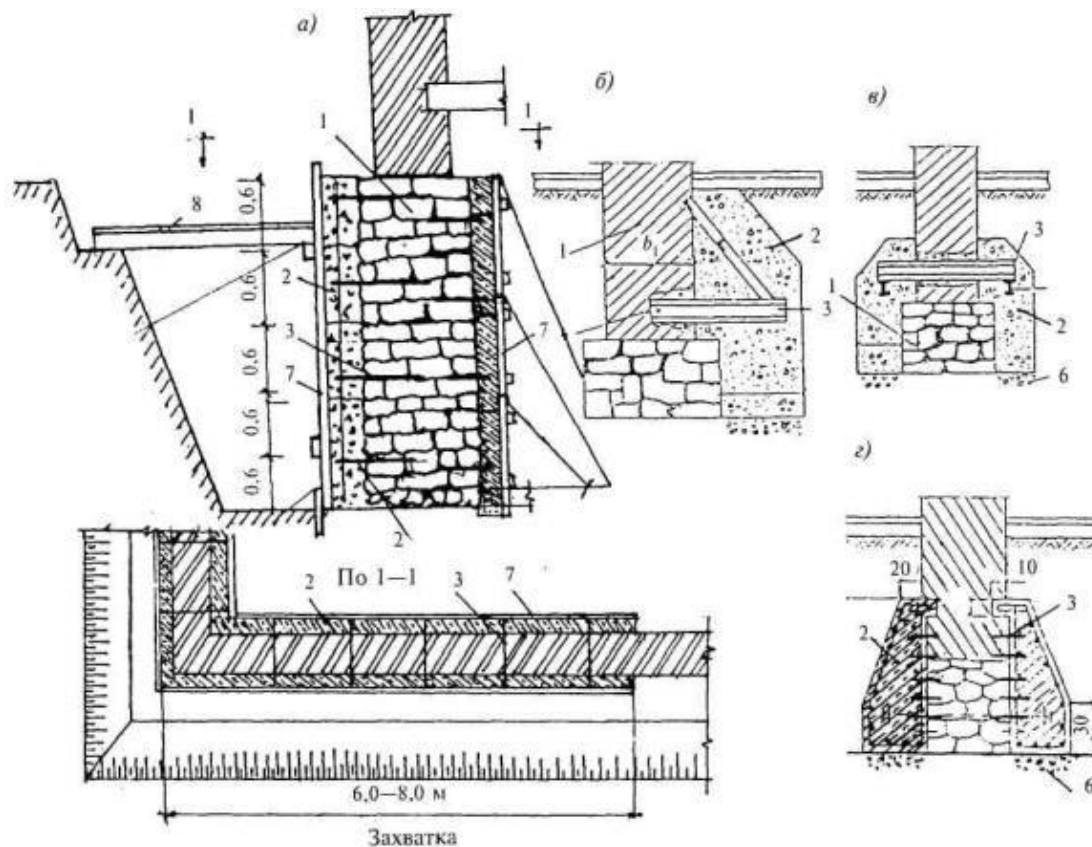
Усиление ленточных фундаментов монолитными обоймами *а* - двустороннее уширение с анкерровкой; *б* - одностороннее расширение; *в* - двустороннее при большом развитии существующего фундамента; *г* - двустороннее при большой глубине заложения фундаментов; 1 - фундаменты; 2 - монолитные железобетонные обоймы; 3 - анкеры из прокатного металла или арматурных стержней; 4 - опалубка; 5 - балки; 6 - щебеночное основание; 7 - опалубка; 8 - рабочий настил.
